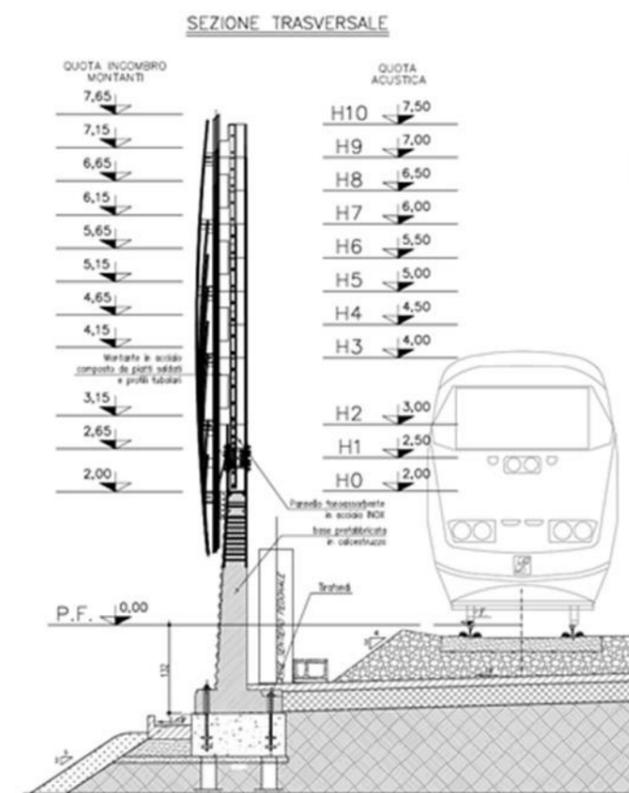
Sezione e prospetto del tipologico di barriera HS verticale
